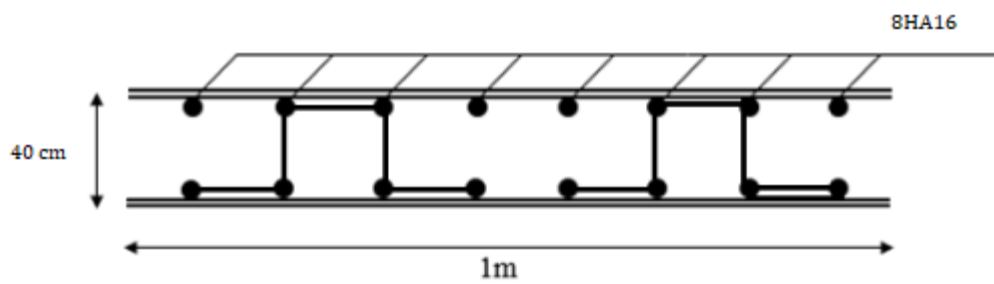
Ferrailage de la dalle du radier sens y-y
